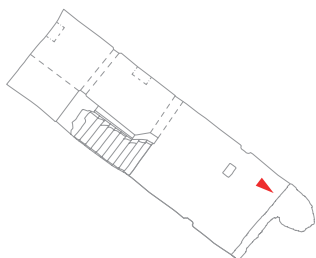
Relevé de l'élévation n° 4 du mur 1042 (salle 1).
